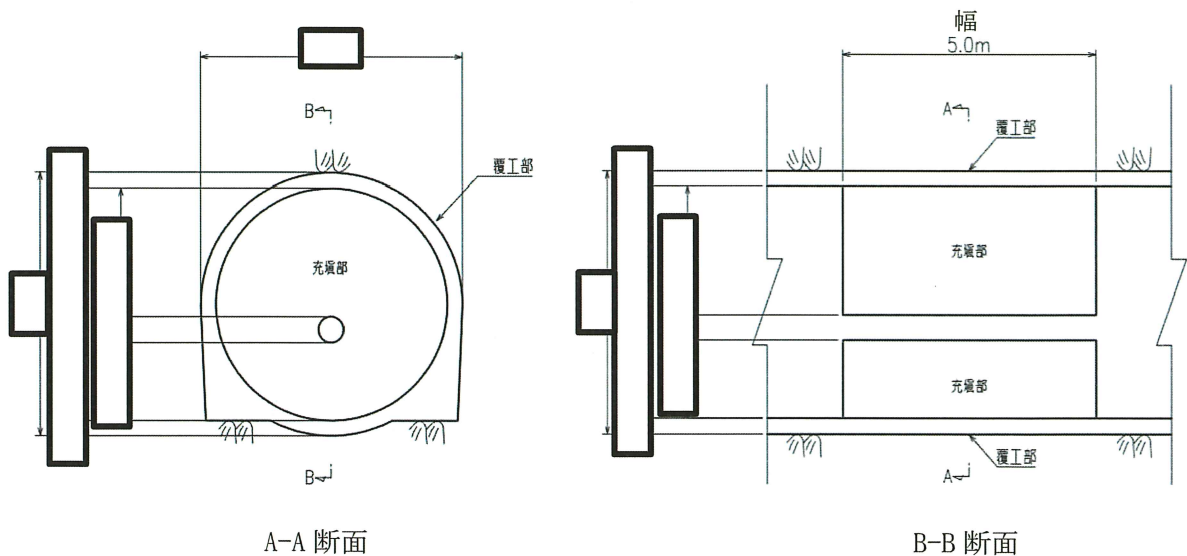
(2) 取放水路流路縮小工（第1号機放水路） 断面図
